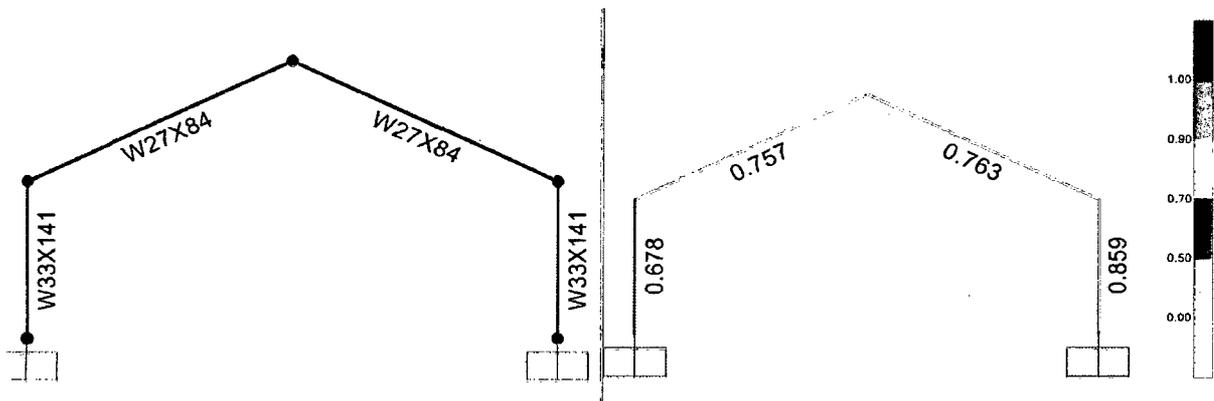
Pórtico Rígido de 20 m. de luz
